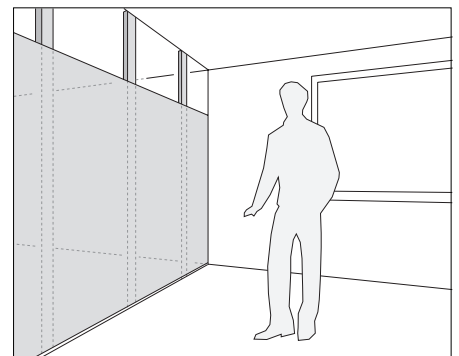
Trennung von Konstruktion und Ausbau am Beispiel einer Leichtbauwand als Ständerkonstruktion und eines Bodenaufbaus mit Trockenestrich
